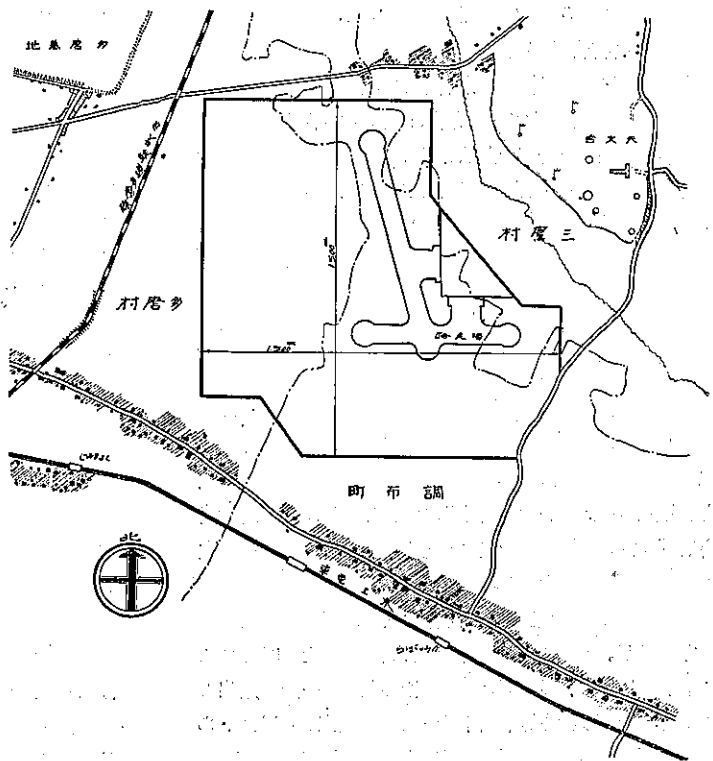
東京都市計畫東京調布飛行場計畫平面圖
